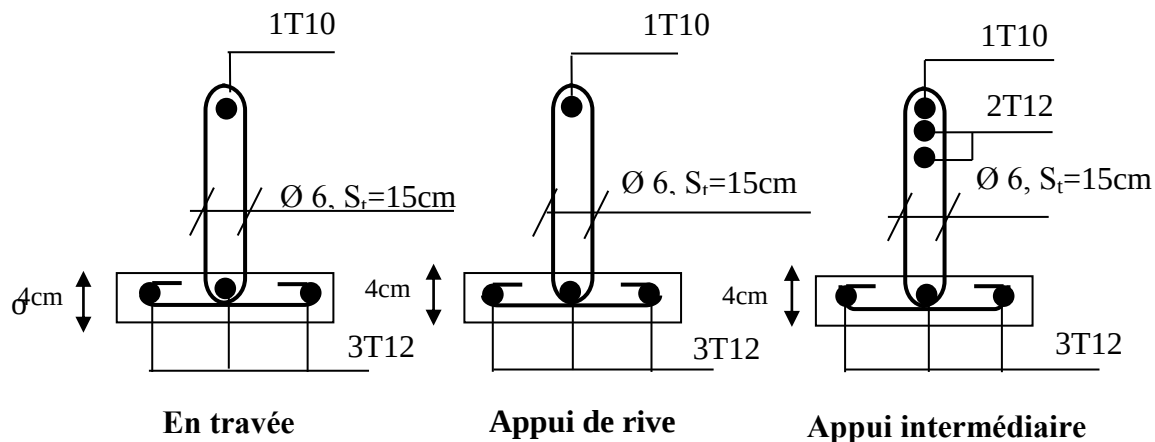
Schéma de ferraillage des poutrelles terrasse
